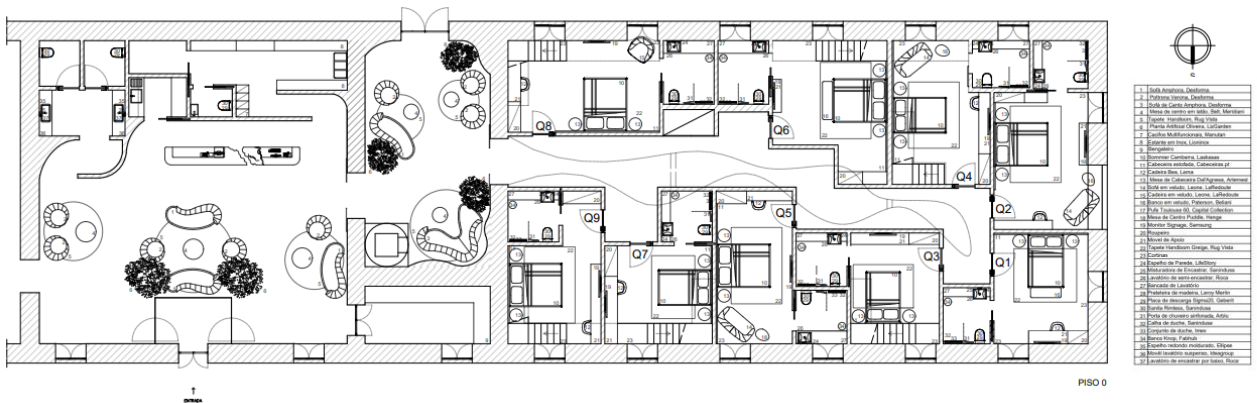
Planta de Mobiliário e Equipamento, Piso 0, Alojamento Olive
